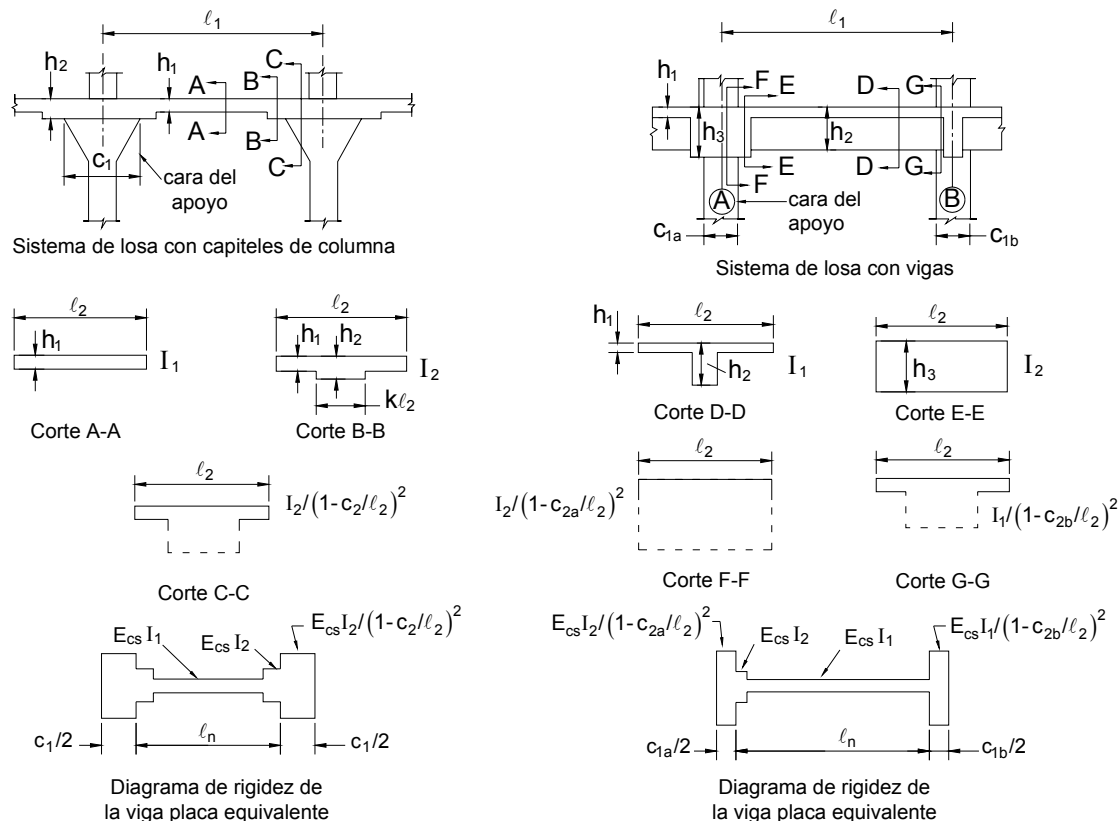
Secciones para calcular las rigideces de las vigas placa, K_{sb}
